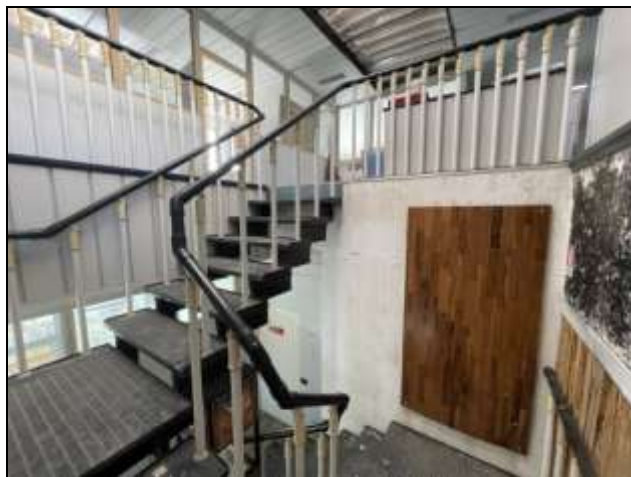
" – PIANO PRIMO – Scala di collegamento con la Zona Filtro posta al p. Terra
